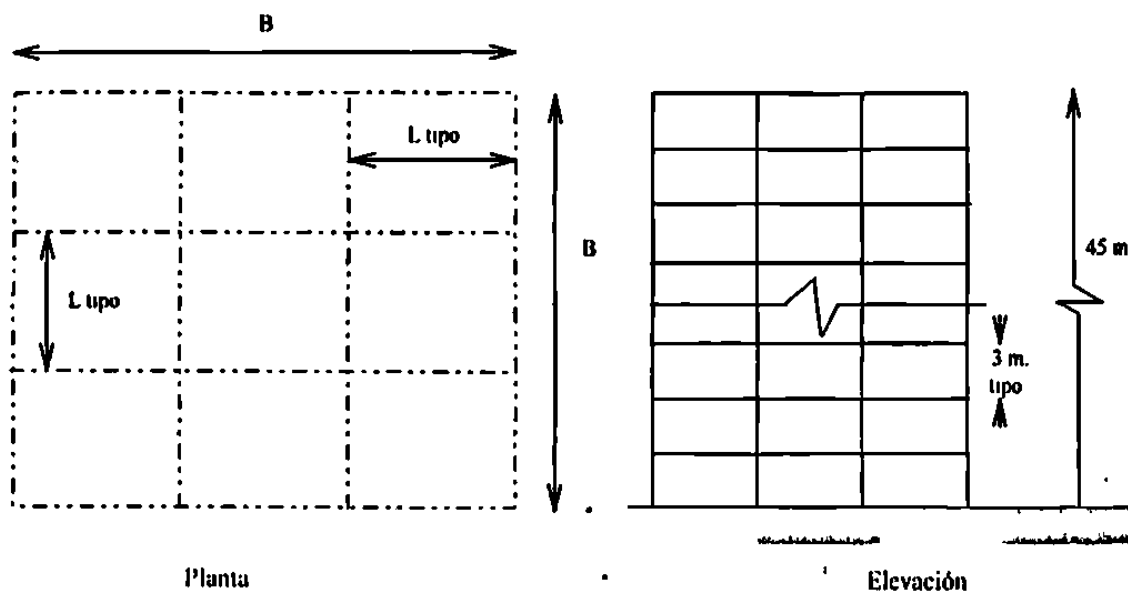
Planta y Elevación de los Edificios No. 2 y 6
